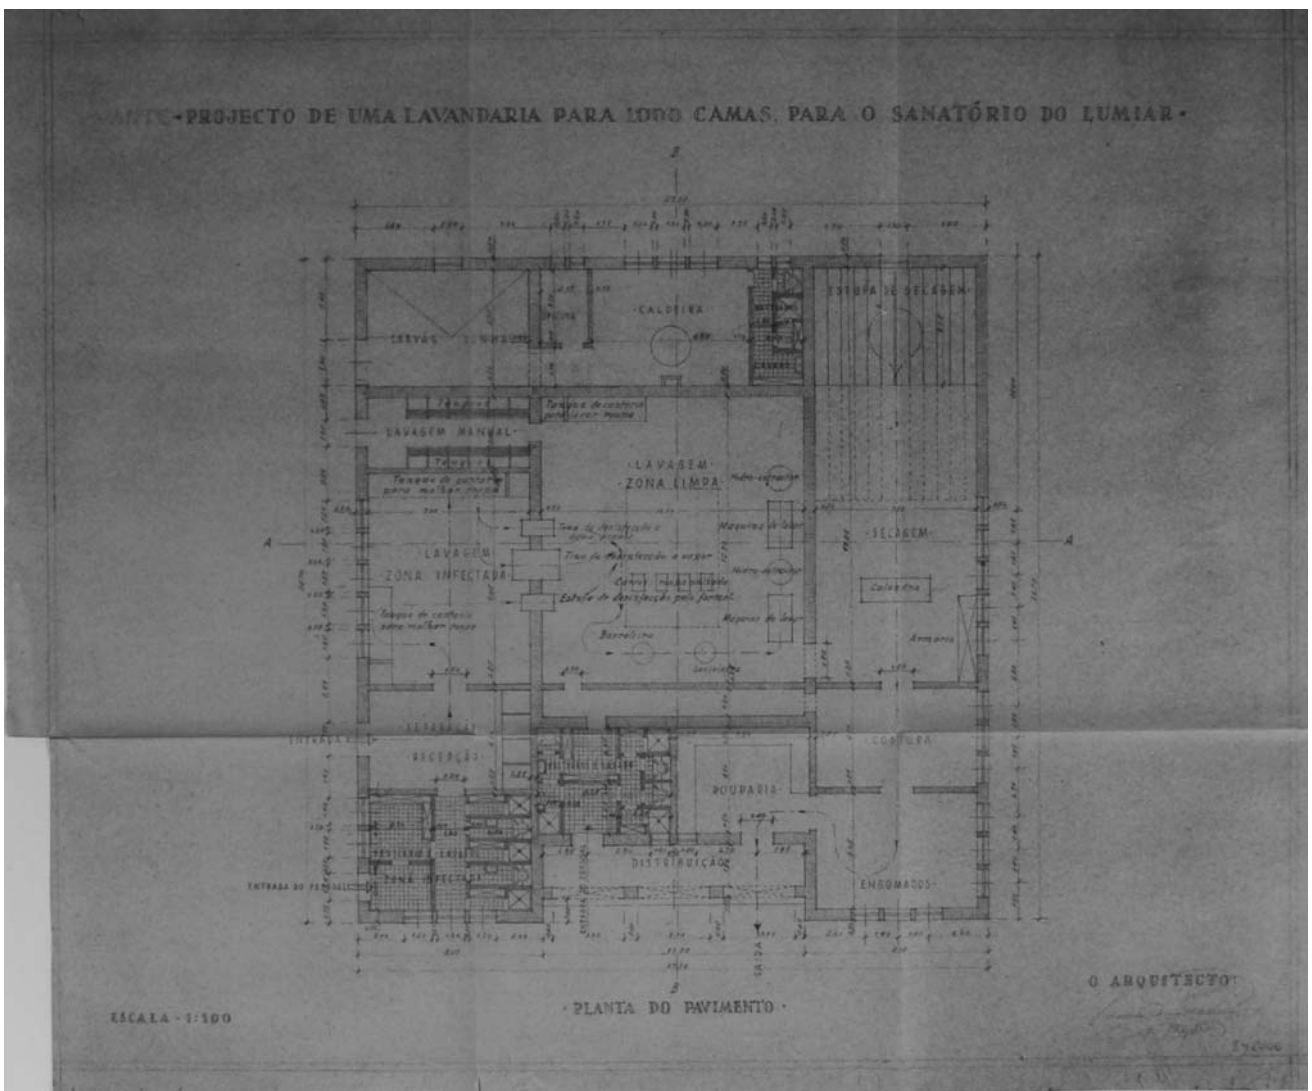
Projecto de uma lavandaria para 1000 camas - Planta do Pavimento. Vasco Regaleira. SIPA: DES\_848006.
